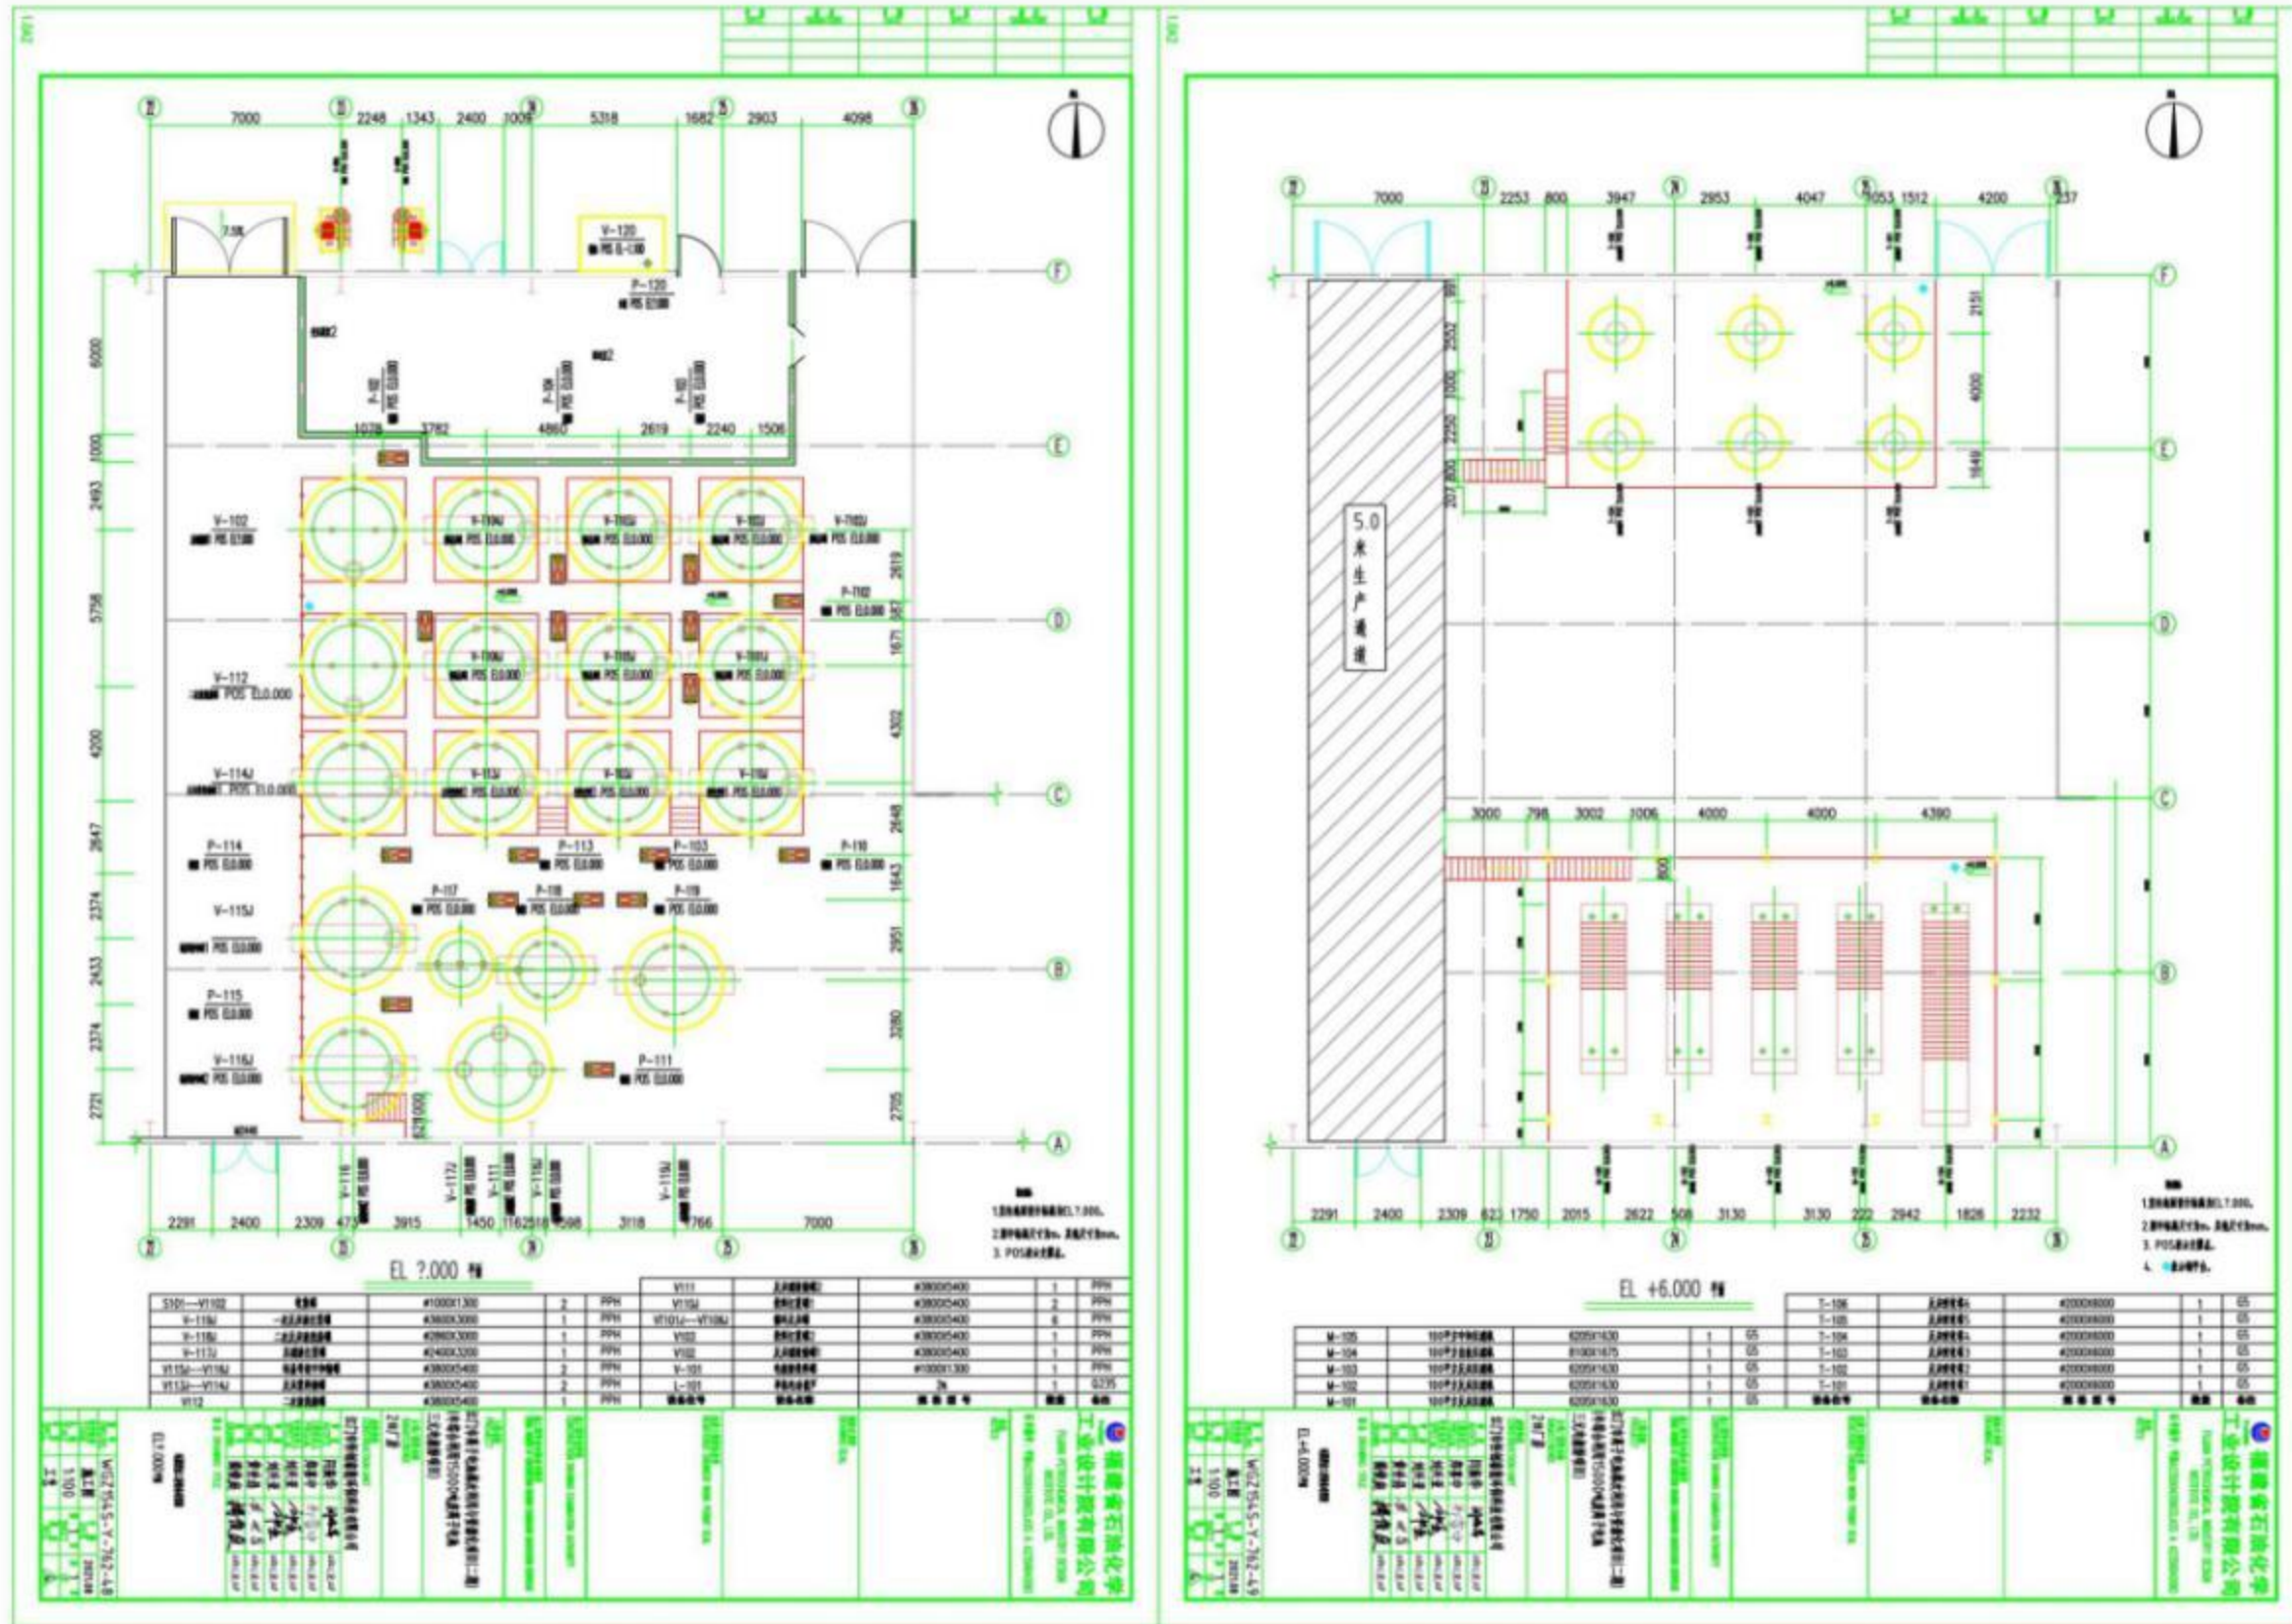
2#厂房-还原浸取区域平面布置图
